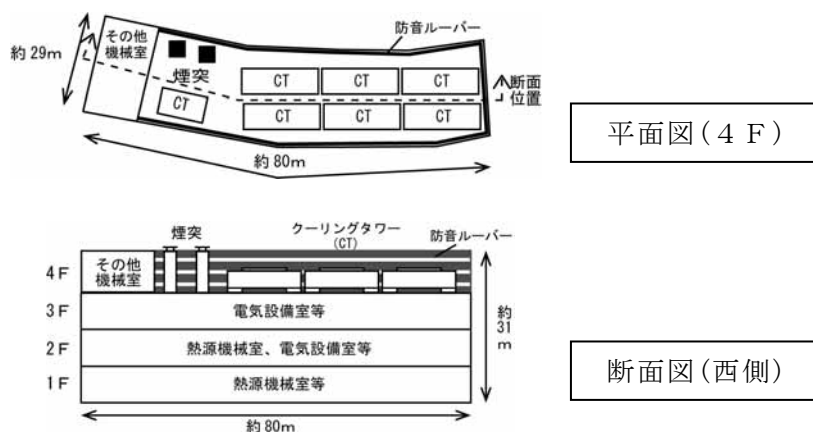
(2) エネルギー施設 B の平面図及び断面図
